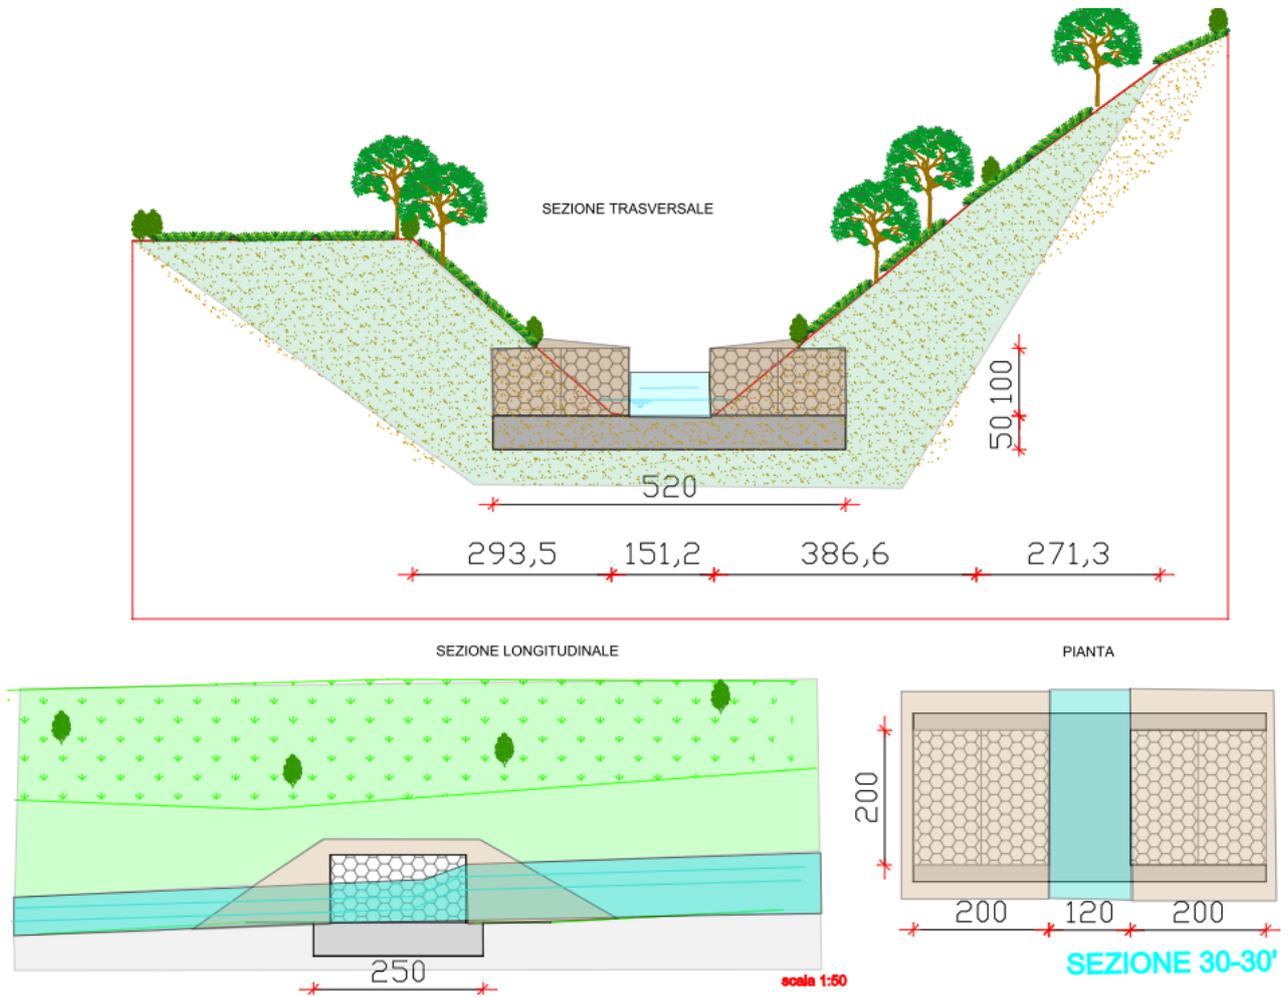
Schema del restringimento di sezione a bocca tarata con anima in pietrame previsto nel tratto incassato posto a monte del tratto arginato a monte della strada provinciale SP.23. In alto l'intervento visto secondo una sezione trasversale all'alveo e in basso secondo una sezione longitudinale (a sinistra) e in pianta (a destra).
